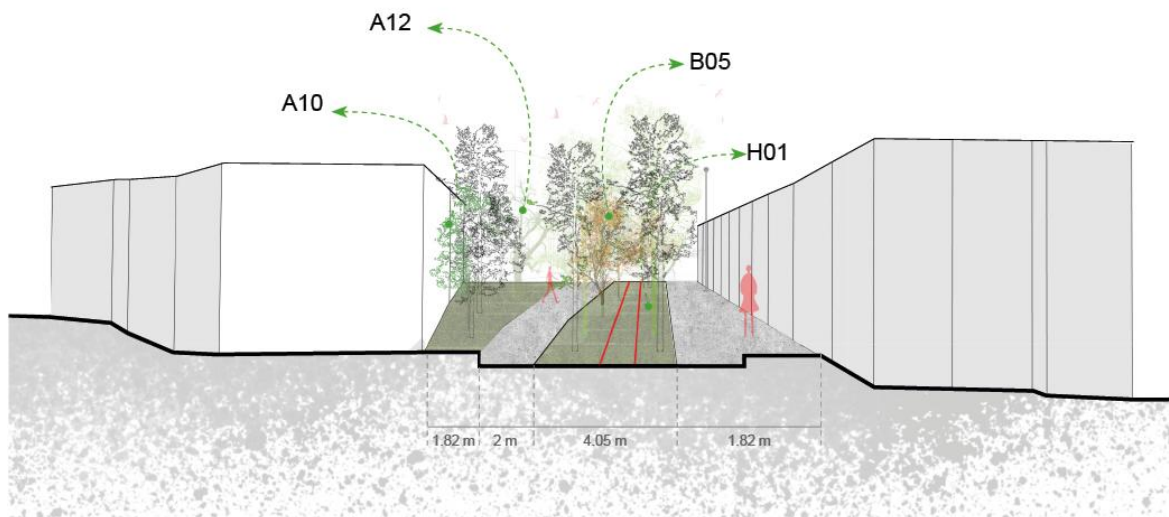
Tramo 1, sección arquitectónica del corredor de Gapa. Elaboración propia (2025).
